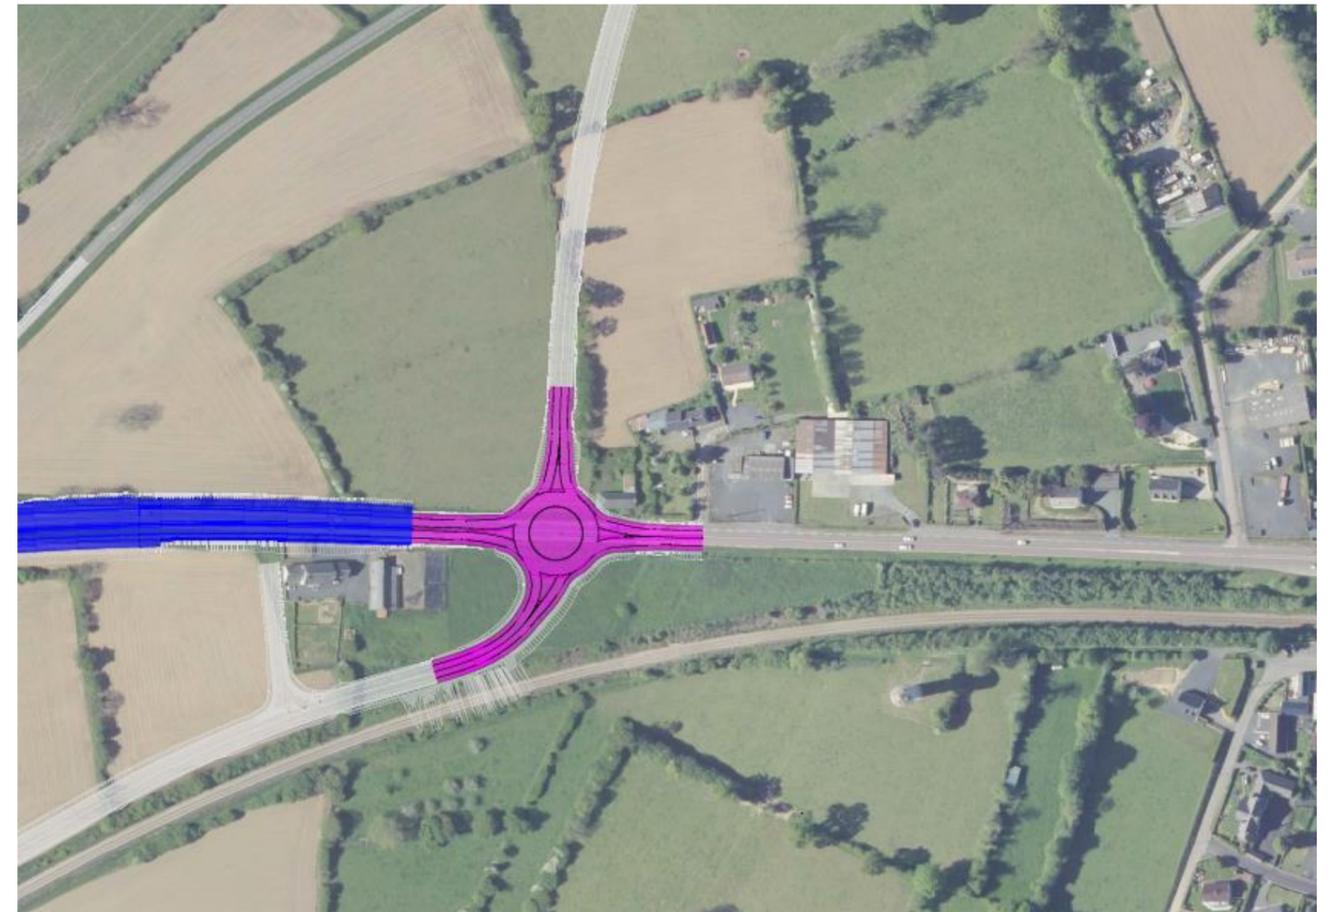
Vue en plan du futur giratoire à l'entrée Ouest de « La Chapelle »
